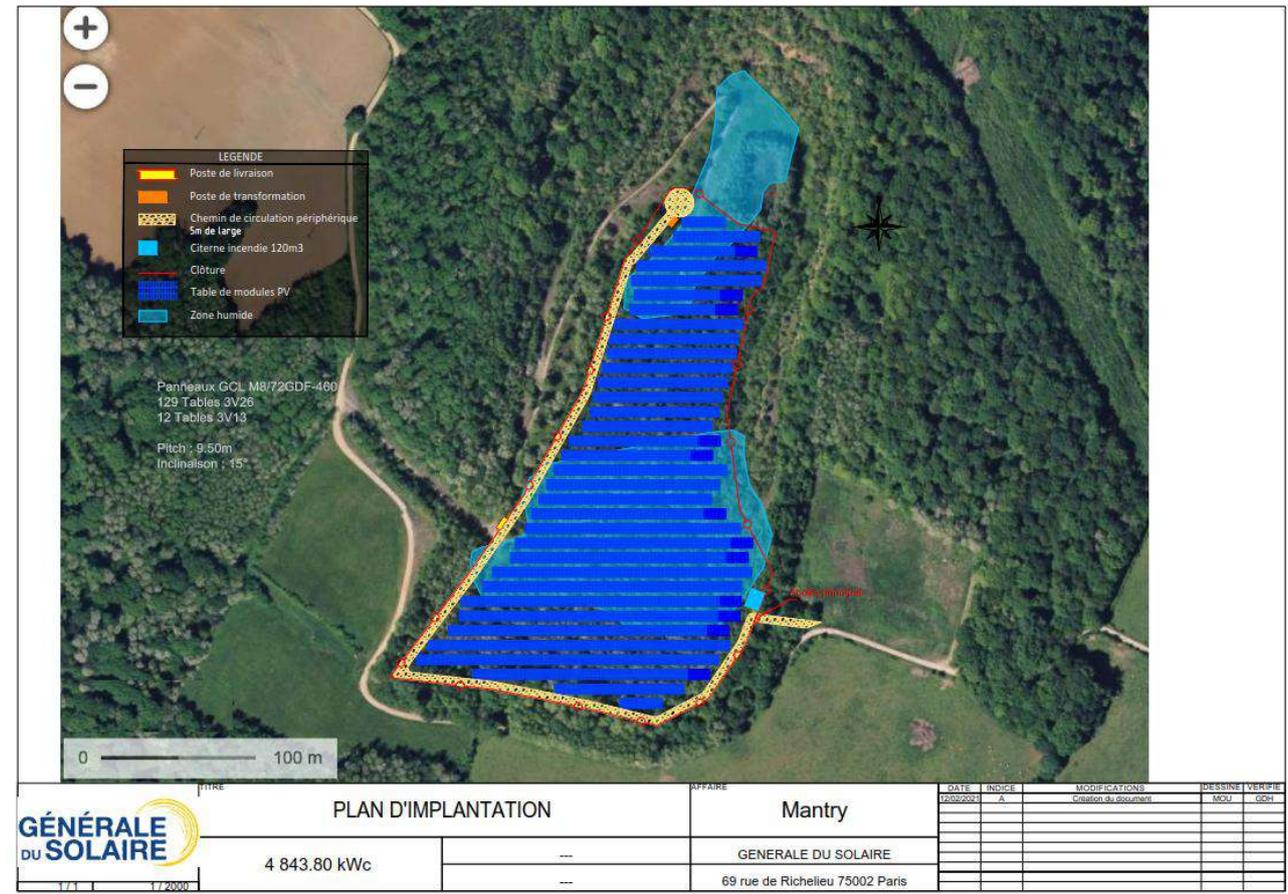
Plan d'implantation générale du projet de centrale solaire
